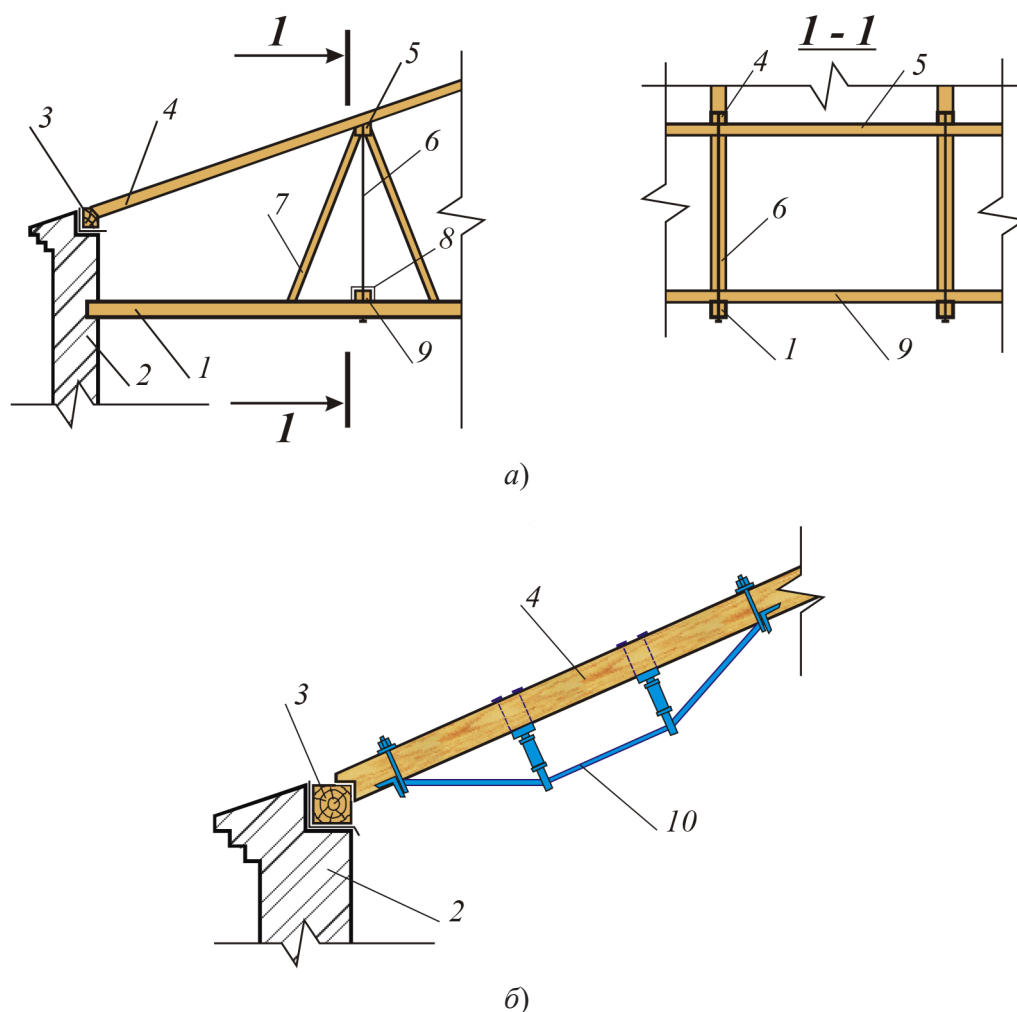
Усиление стропильных ног шпренгельными фермами: *а* – деревянными; *б* – металлическими; 1 – балка чердачного перекрытия; 2 – стена; 3 – мауэрлат; 4 – стропильная нога; 5 – распределительный прогон; 6 – стальной тязь  $\varnothing 24$  мм; 7 – подкосы; 8 – башмак-упор; 9 – прогон; 10 – шпренгельная ферма
